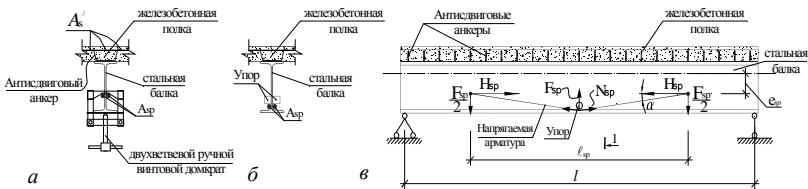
Локальное обжатие сталежелезобетонной балки:
